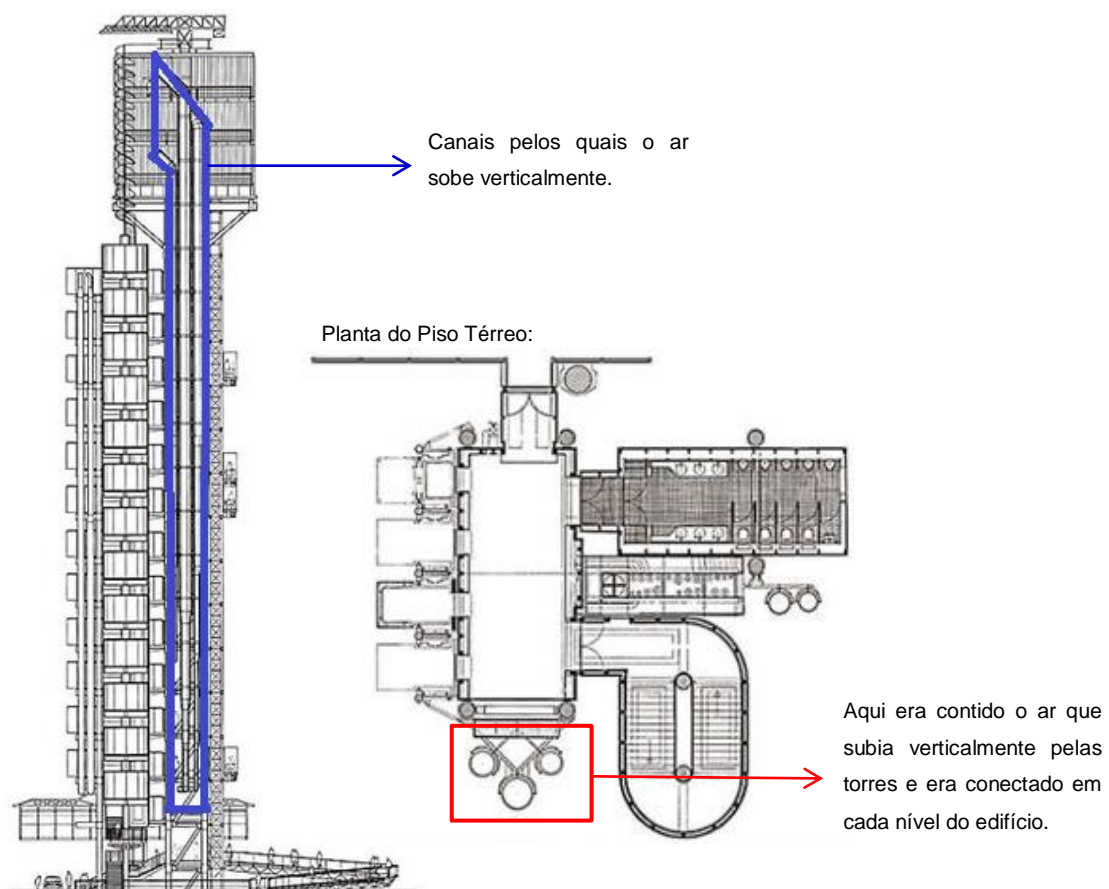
Edifício Lloyd’s Building e respectiva planta do piso térreo (adaptado de Google Images)
